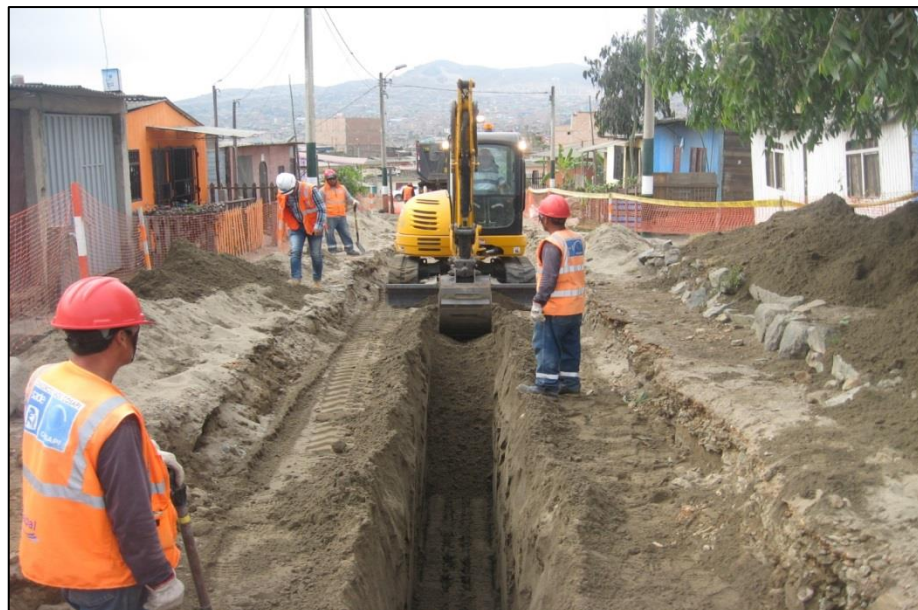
Excavación tipo I en red de alcantarillado (TI-002).
